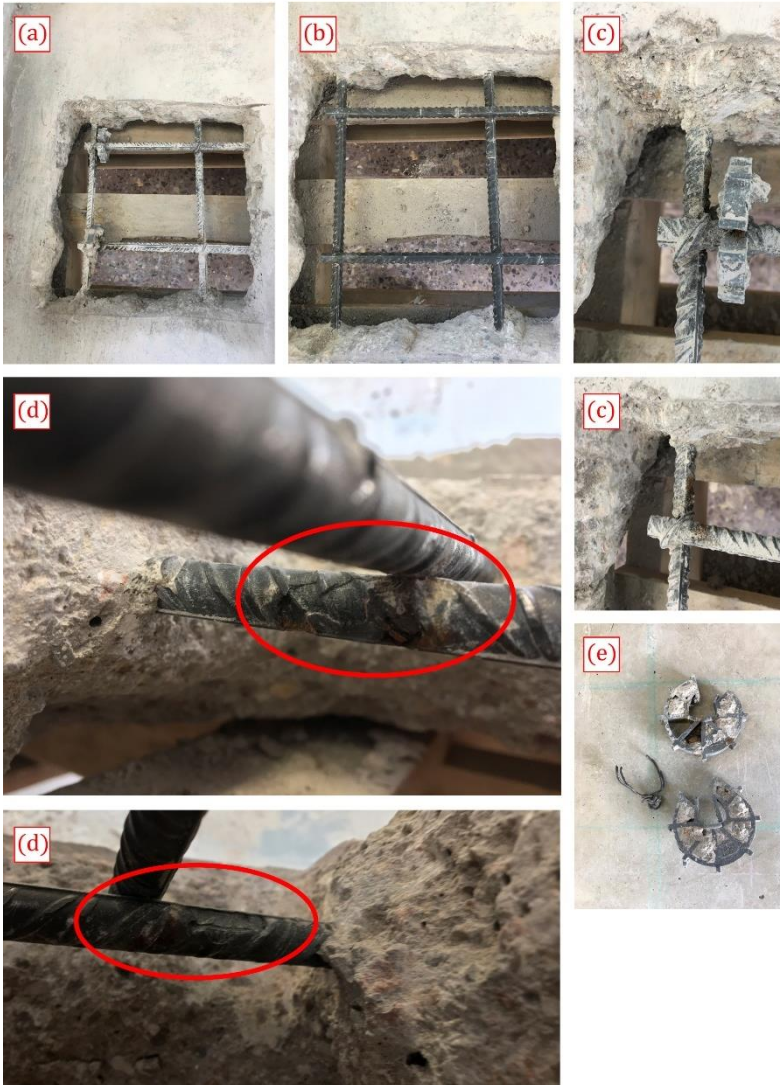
44- Inspección visual de las armaduras: (a) y (b) antes/después del cepillado, (c) detalle del armado próximo a una intersección y zona con roseta, (d) detalles de picadura y (e) estado de las rosetas y los alambres de atado. Elaboración propia.
